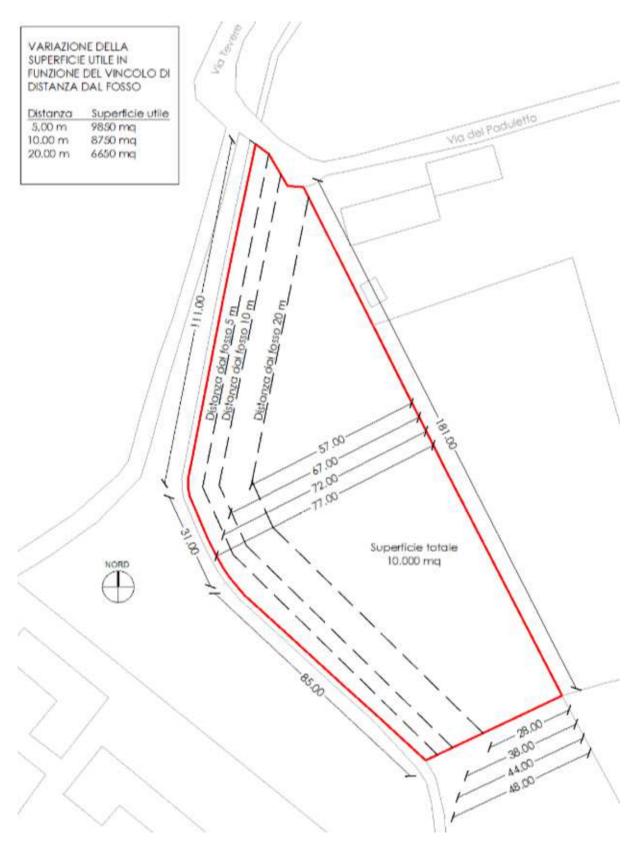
Pianta con indicazione delle dimensioni del CdR e delle fasce di rispetto
